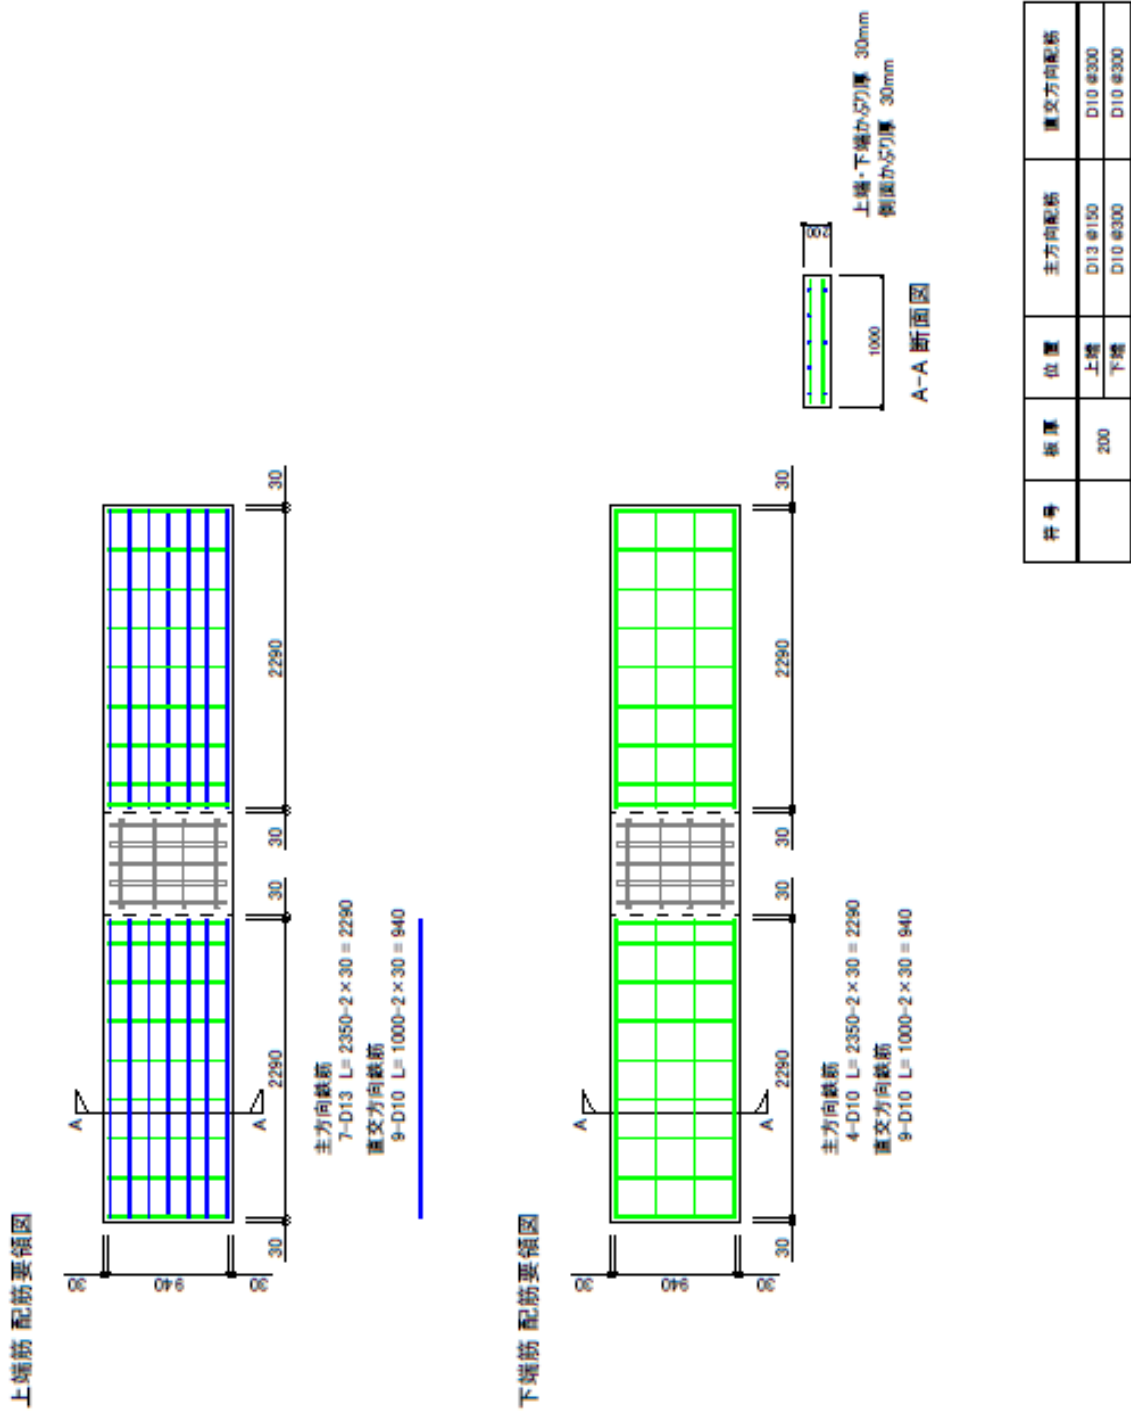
スラブ配筋図 (CA, CB 試験体)
